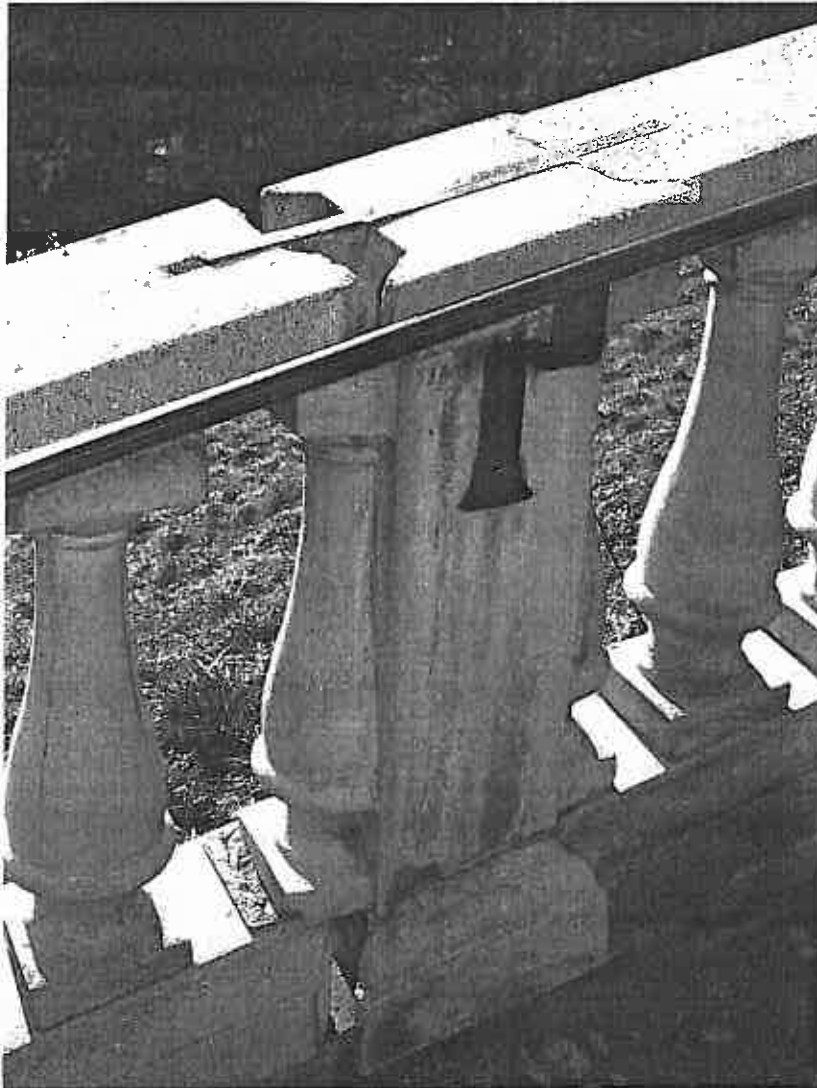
particolare di un distacco tra gli elementi del parapetto a lato della strada
